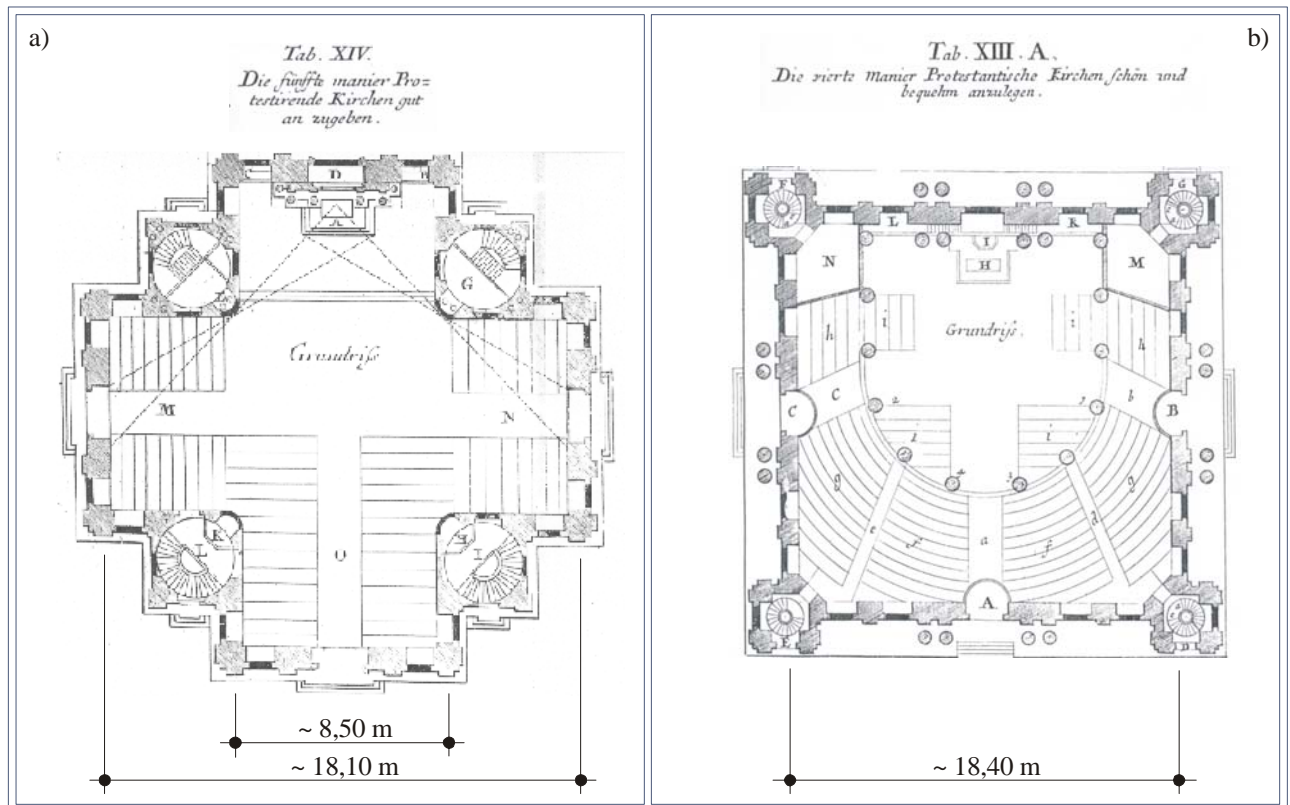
Grundrisse, nach denen gemäß der bauteoretischen Schriften von LEONHARD CHRISTOPH STURM protestantische Kirchen zu errichten sind (Auszug).<sup>8</sup>
